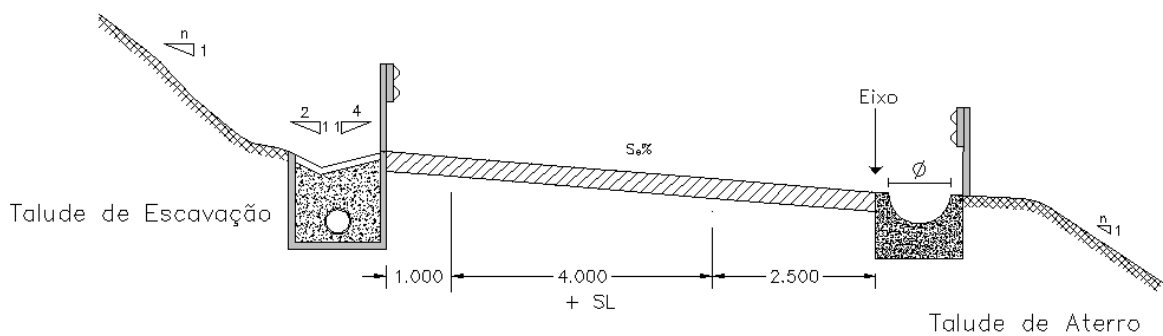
Perfil Transversal Tipo do Ramo B - PK 115,000 m
